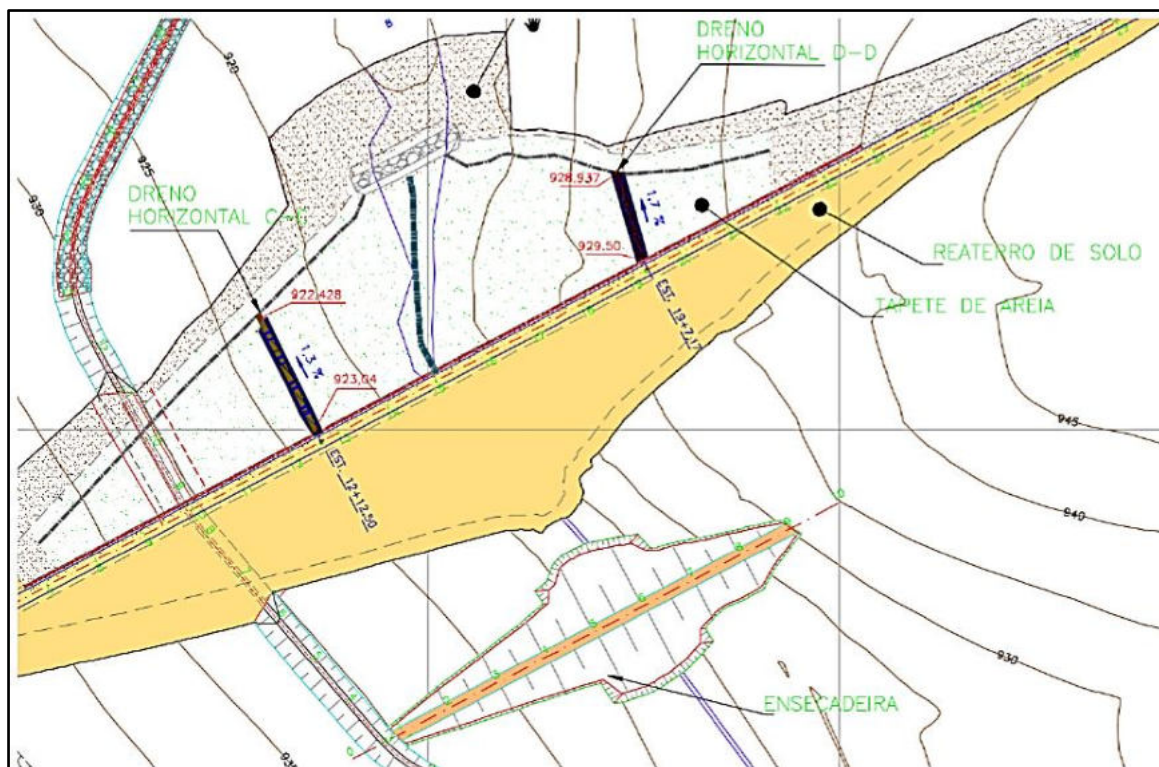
Dreno de fundo da barragem B6 em vista frontal (PIMENTA E PAVIDEZ, 2018)
